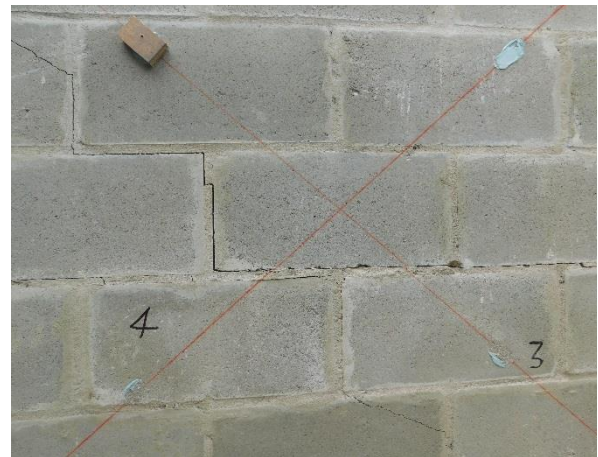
Fisuras en la cara frontal del muro MD-2#4/60
